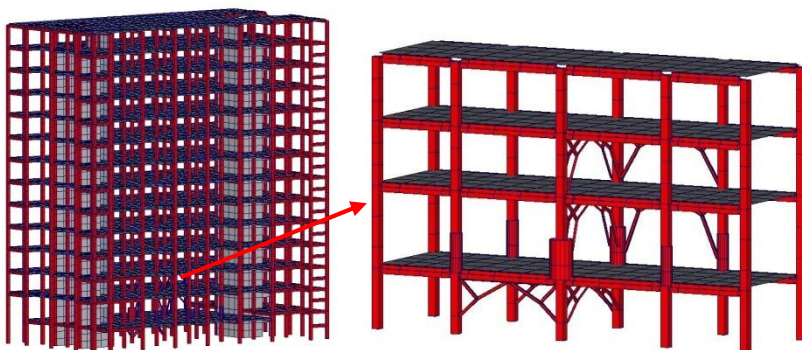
Фрагмент пространственного блока с учетом усиления колонн и установки металлических порталных связей
